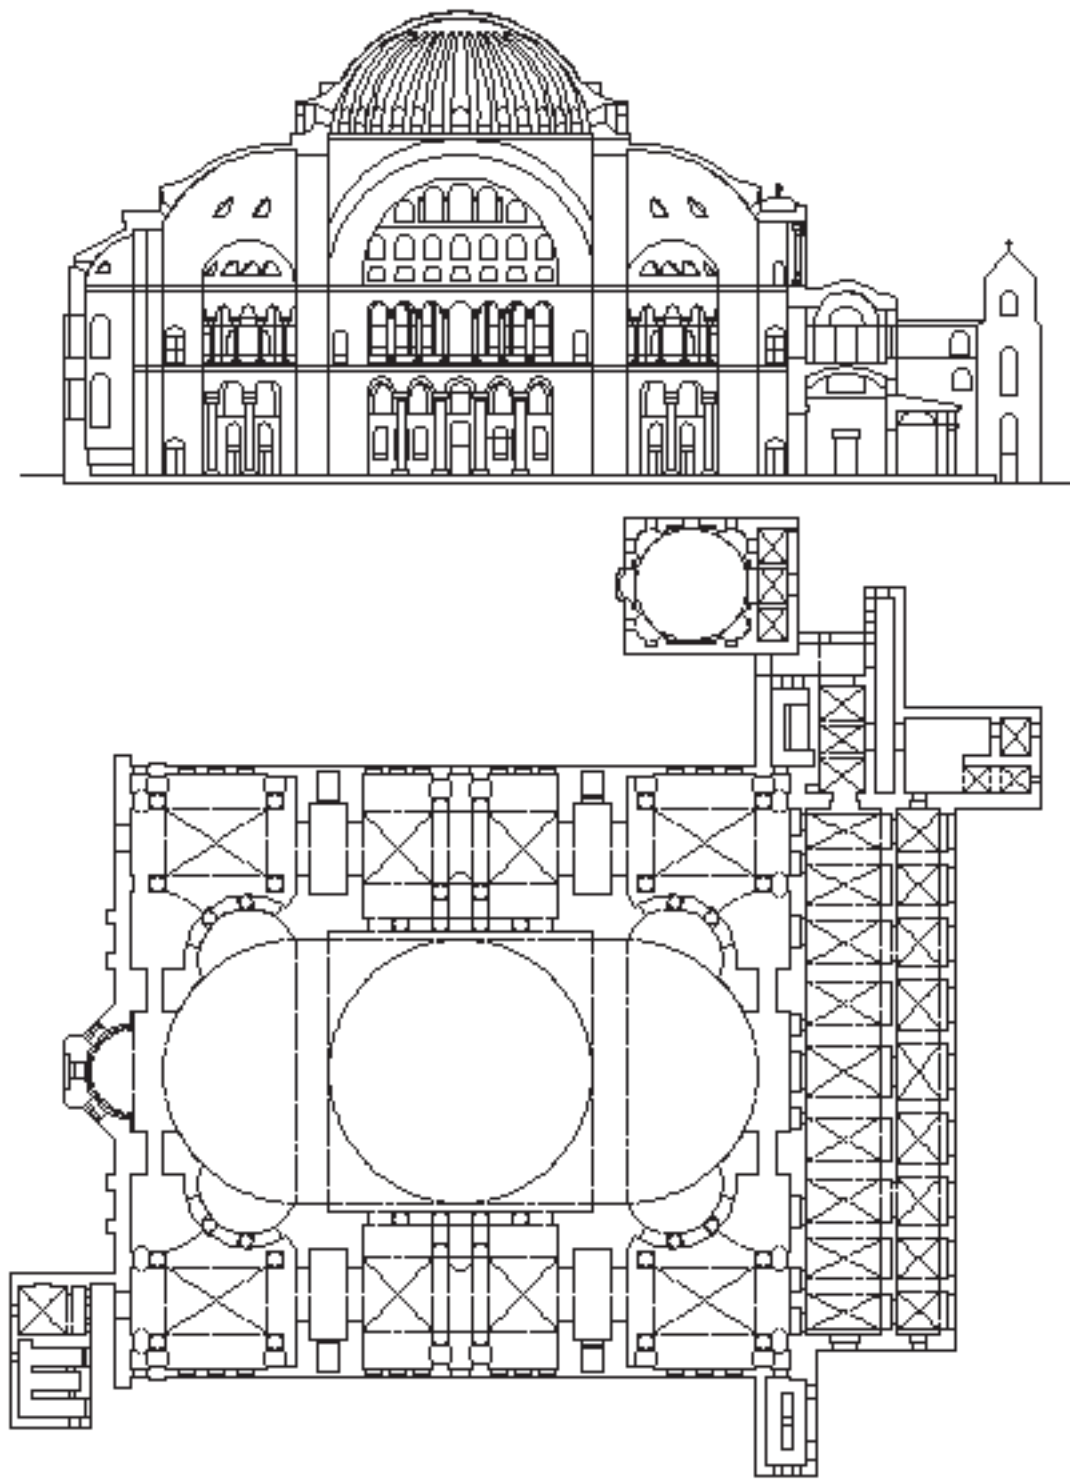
Planta y sección longitudinal de Santa Sofía. (Dibujo del autor).
